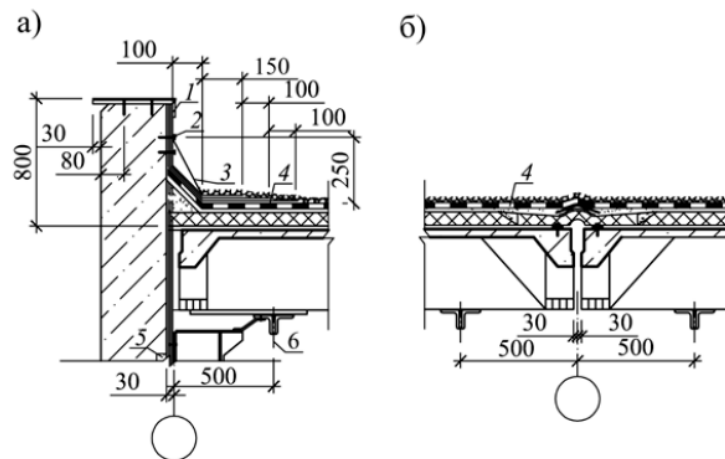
Розрізи покрівлі вздовж будівлі: а – парапет; б – влаштування деформаційного шва: 1 – кріпильний куттик; 2 – дюбелі з кроком 600 мм; 3 – фартух з оцинкованої сталі; 4 – рулонна покрівля; 5 – кутикова насадка і сталева надставка фахверка; 6 – вісь кроквяної ферми
